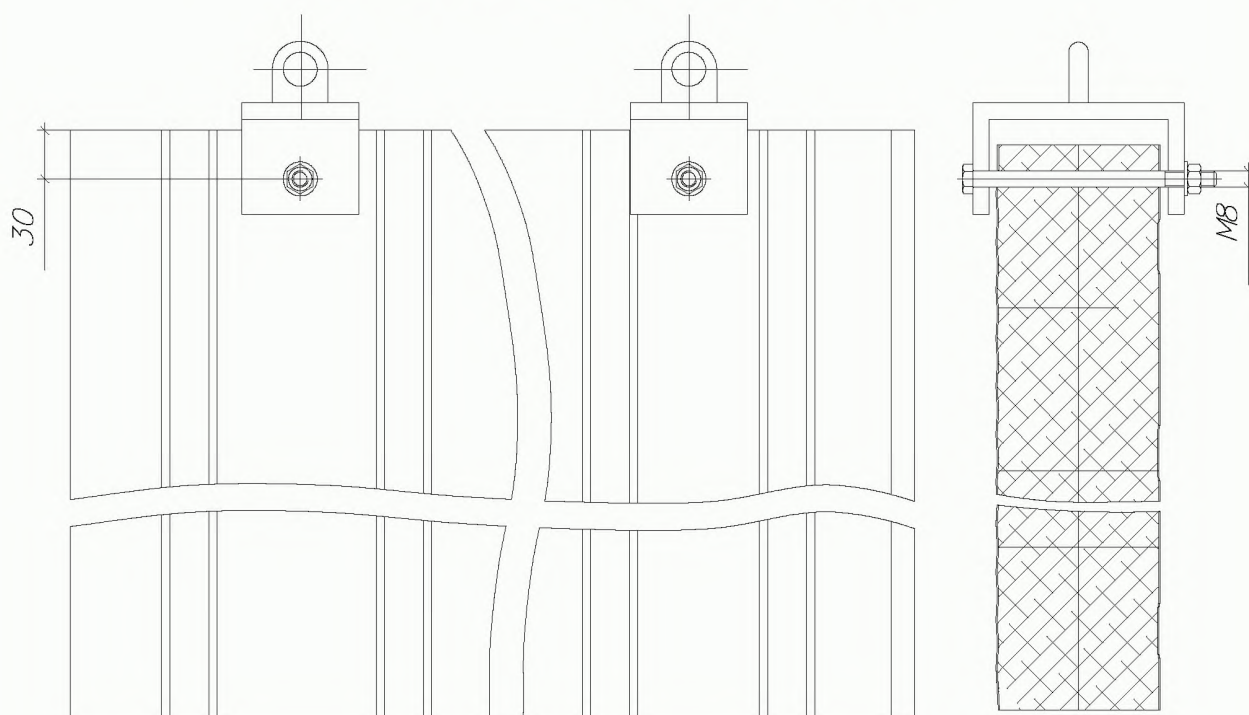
а – Транспортирование и укладка стеновых панелей на месте монтажа
